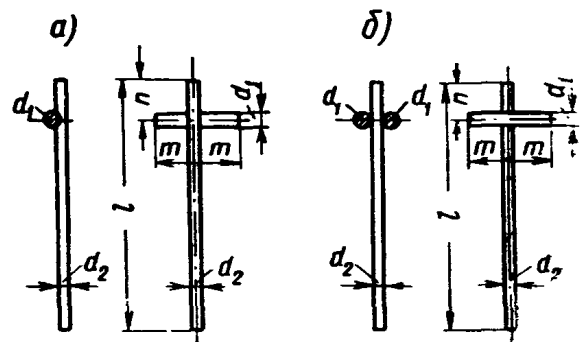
Образцы крестообразных сварных соединений для испытания на срез
